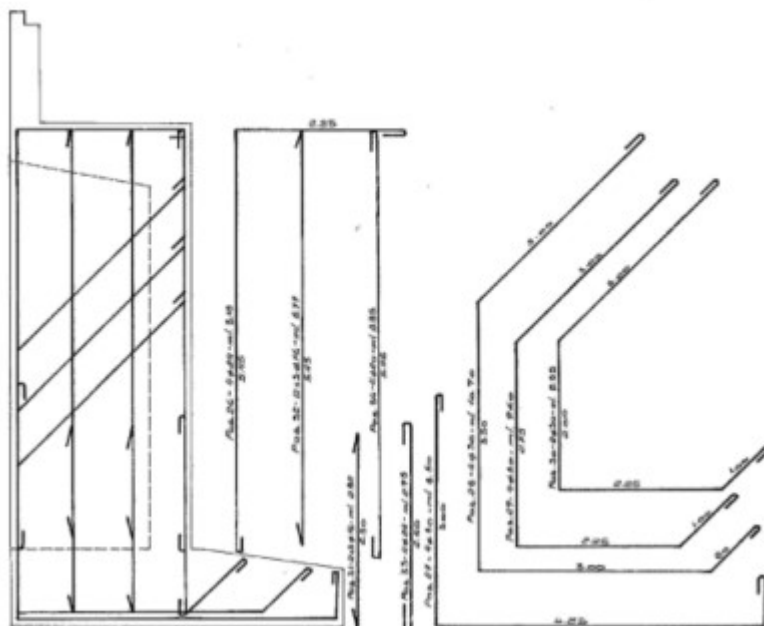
Documento as-built “Sottovia Interconnessione 1 dell’autostrada A14 al km 14+232” – Sezione trasversale con armature contrafforti.
